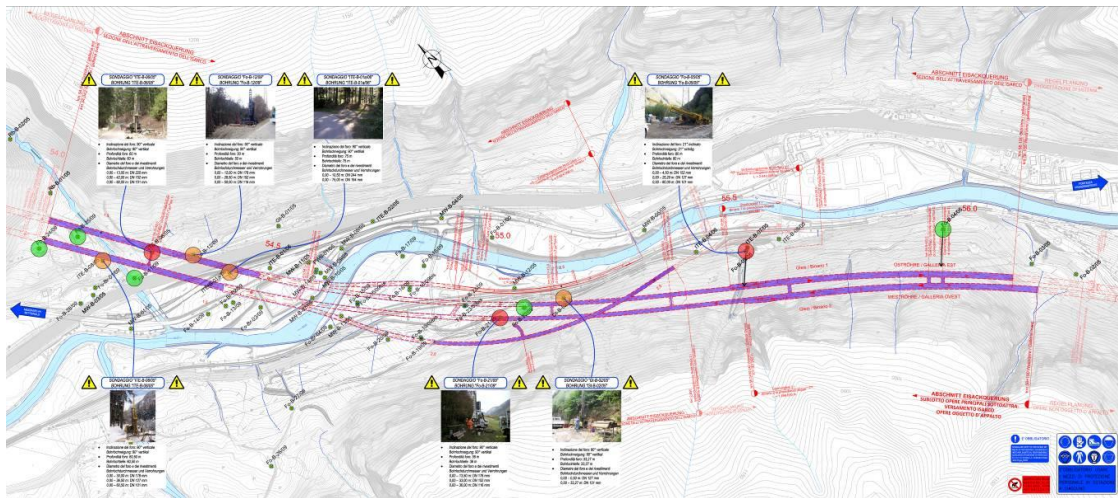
Auszug vom Lageplan Lokalisierung der Bohrungen
